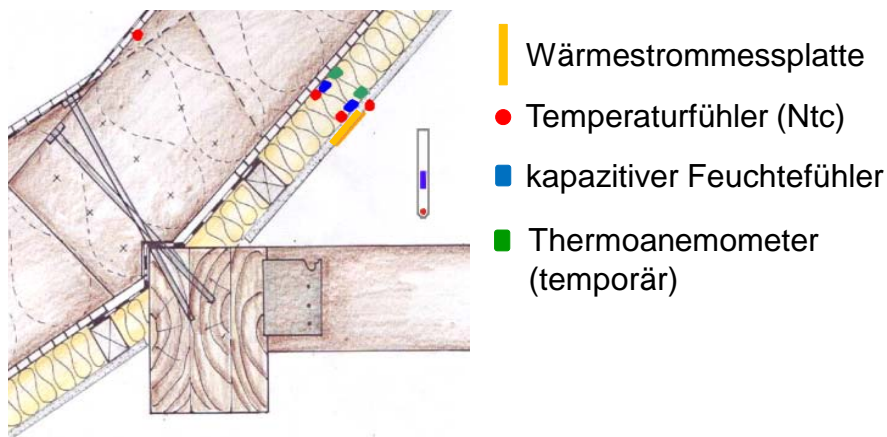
Aufbau der Messstrecken im 3. Dachgeschoss (Spitzboden)
